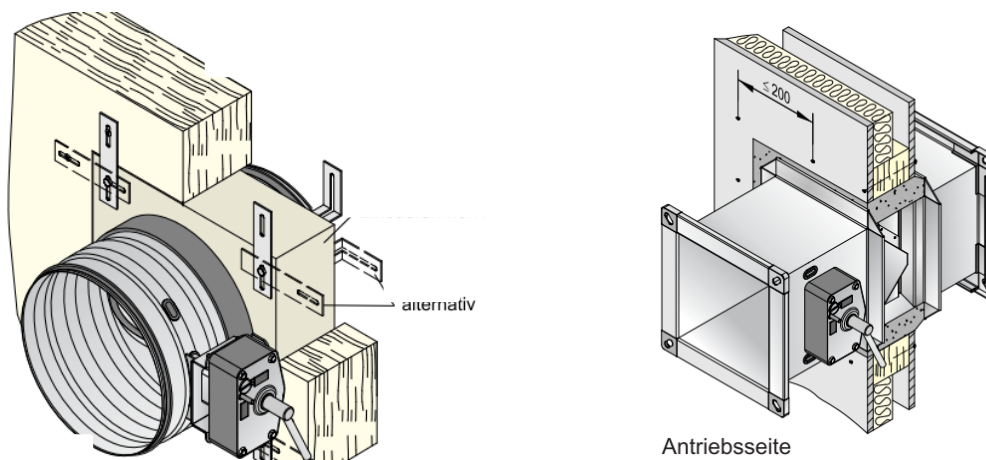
Einbau in Wände und Decken in Holzmassivbauweise mit Einbaurahmen und Holzrahmenbauweise mit Mörtelschott (Bild: Wildeboer Bauteile GmbH [187], [188])
